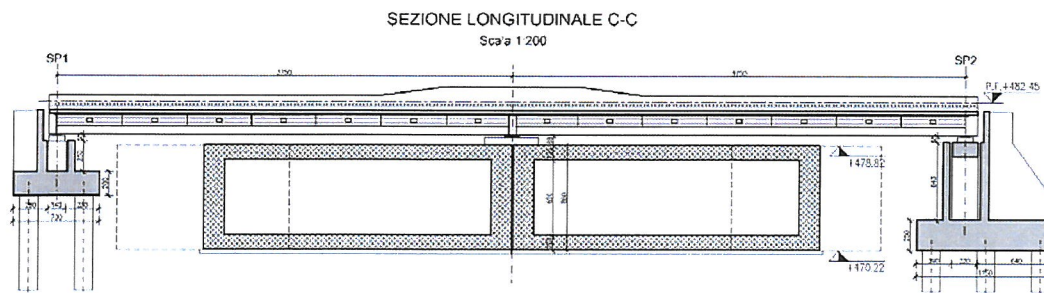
Sezione longitudinale impalcato in progetto per attraversamento A32
